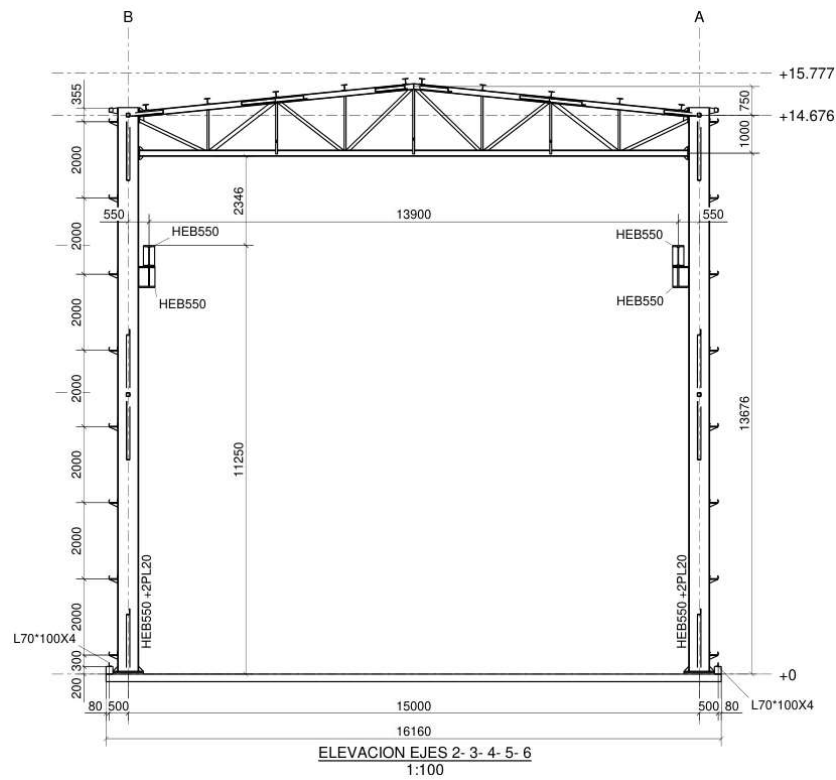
Elevación ejes 2- 3- 4- 5- 6 Nave Metálica grupo 1.
